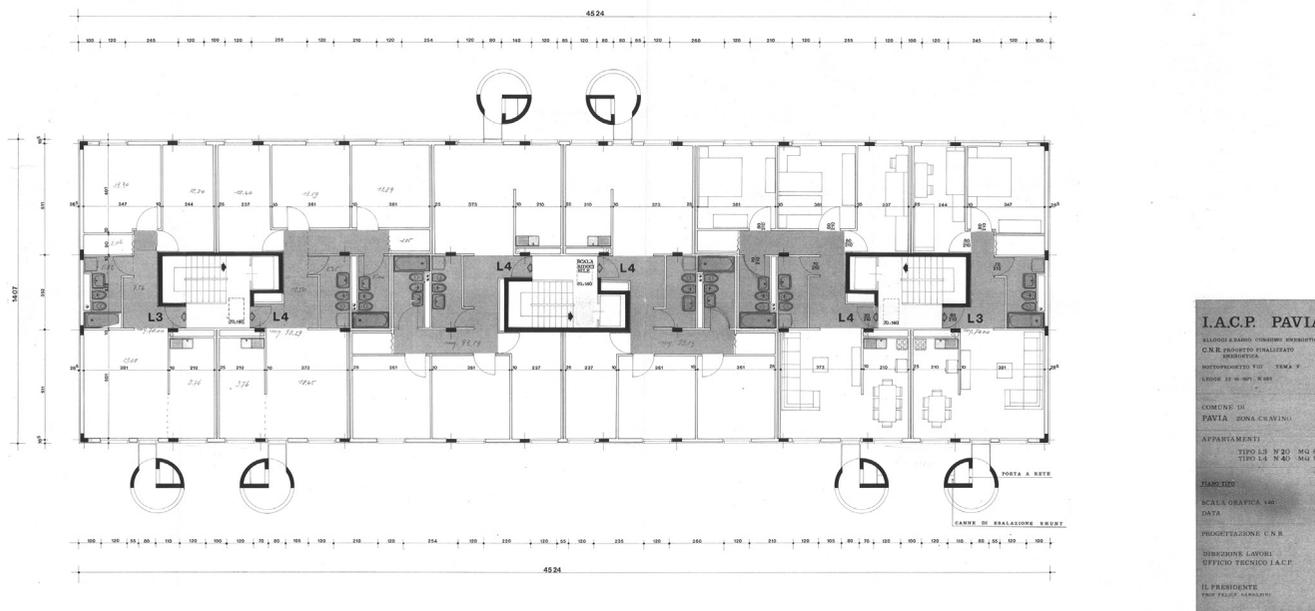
Pianta del piano tipo del Quartiere in località Cravino (1977-81) Pavia (fonte: Archivio ALER Pavia)
